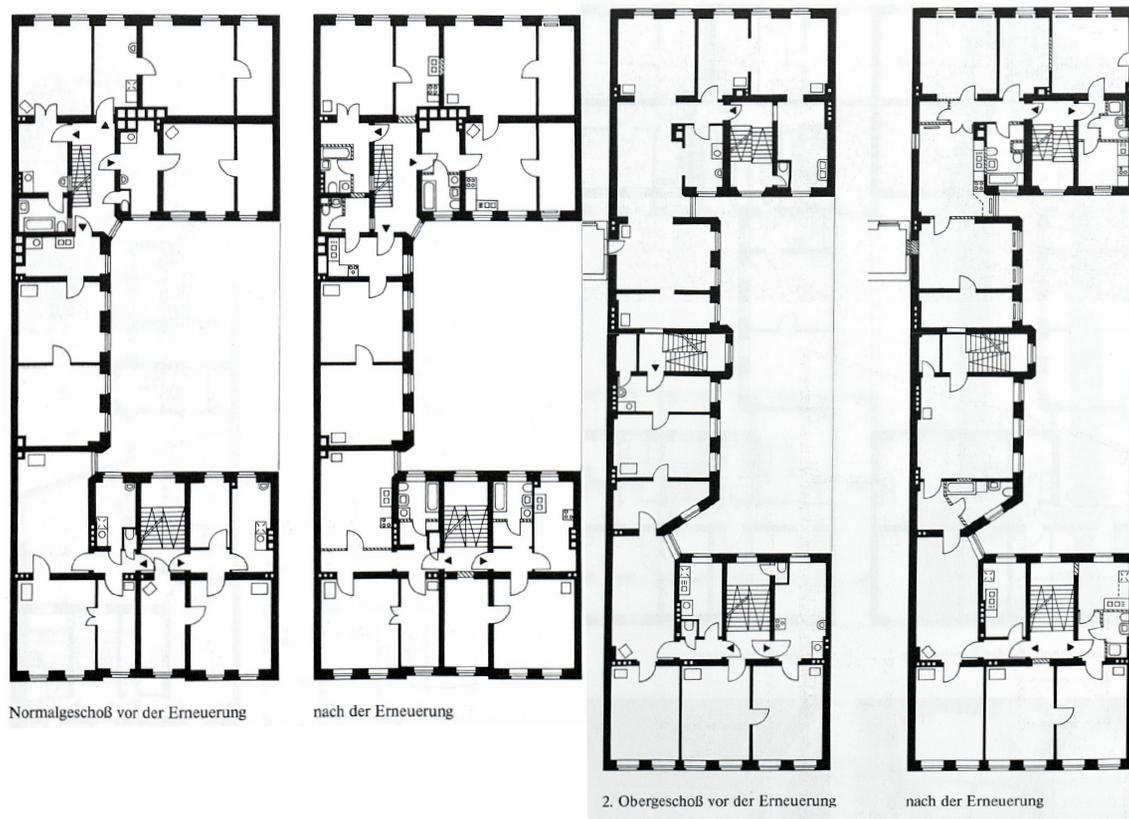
/25: Grundrissveränderung mit Einbau von Küche und Bad in der Oranienstraße 171 und der Naunynstraße 72.
